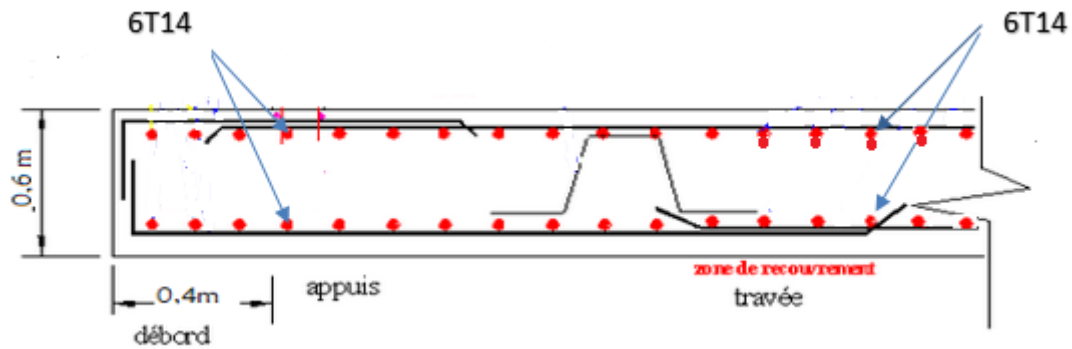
Plan de ferrailage du radier général suivant x-x.
